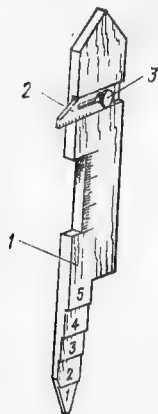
1 — щуп; 2 — движок; 3 — винт
